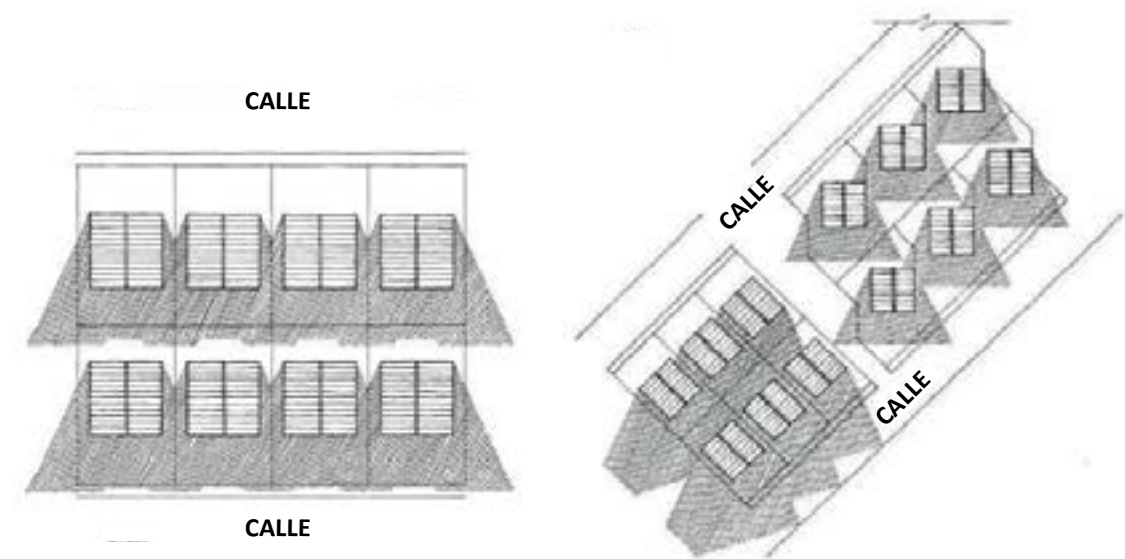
Calles en sentido oriente poniente permiten acceso solar en fachada norte. y Flexibilidad de lotes que permiten mantener orientación norte
